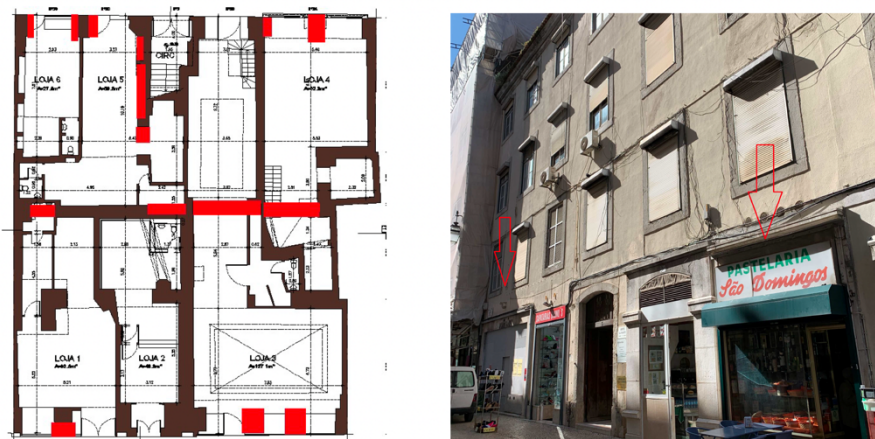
Piso 0. Paredes principais removidas (vermelho). Alçado da Rua Dom Antão de Almada com montras executadas após eliminação de paredes (setas vermelhas). Fonte: Relatório sobre o sistema estrutural da autoria do Engenheiro Luís Gião Marques.
